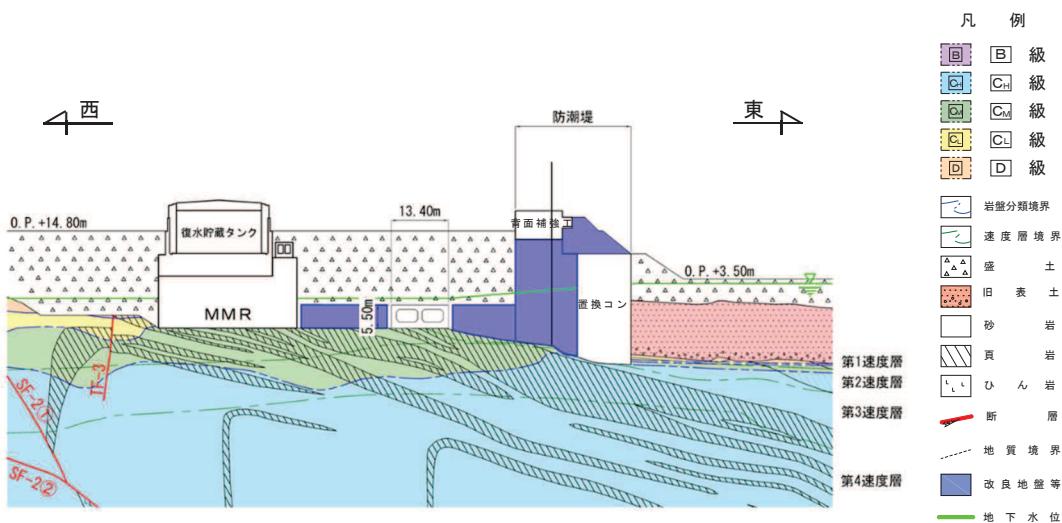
取水路（標準部）地質断面図（断面⑦：曲線部）
